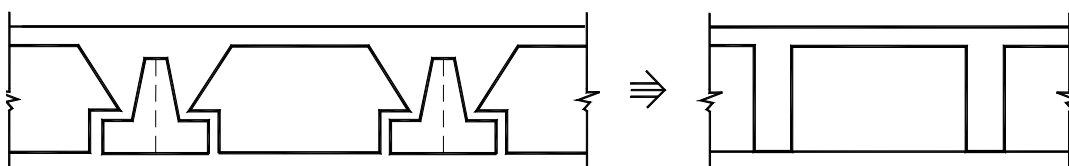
Seções transversais de lajes pré-moldadas e amadura da laje tipo treliça
